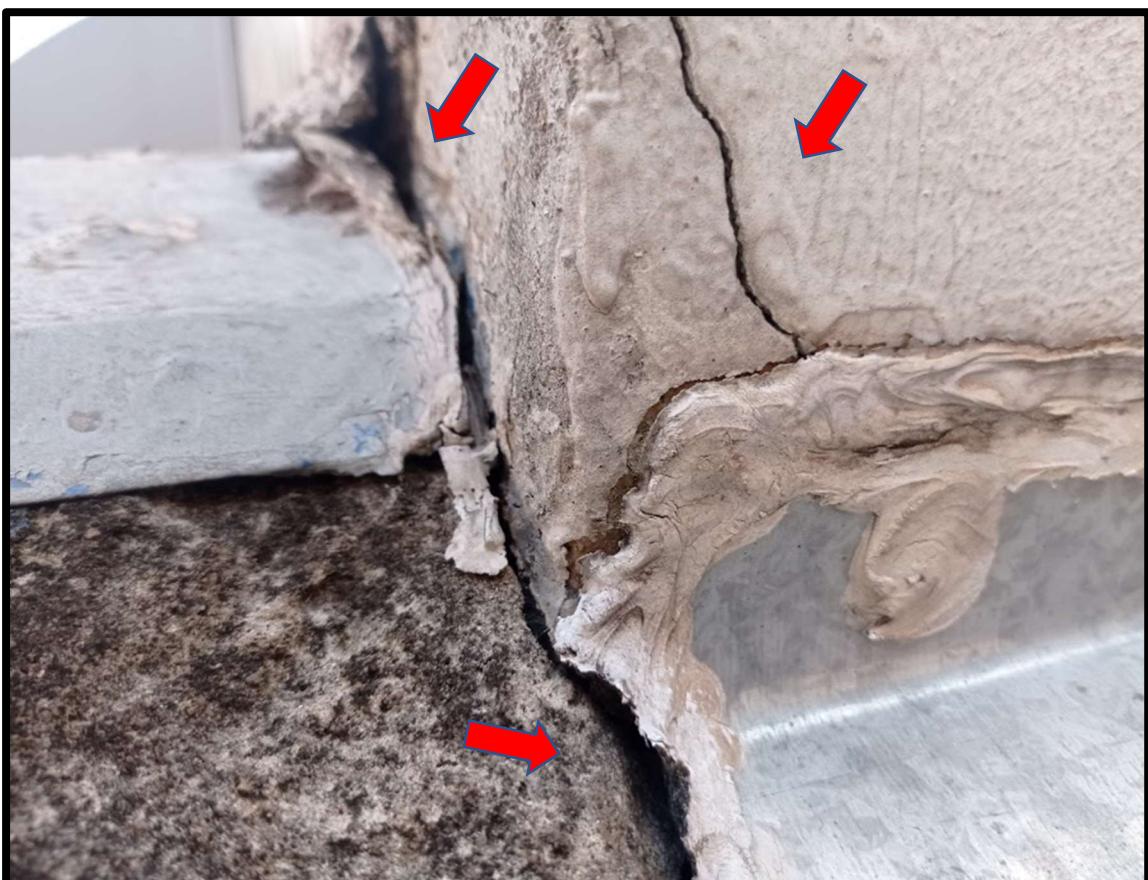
Visto do rufo do imovel inspecionado com falhas.
